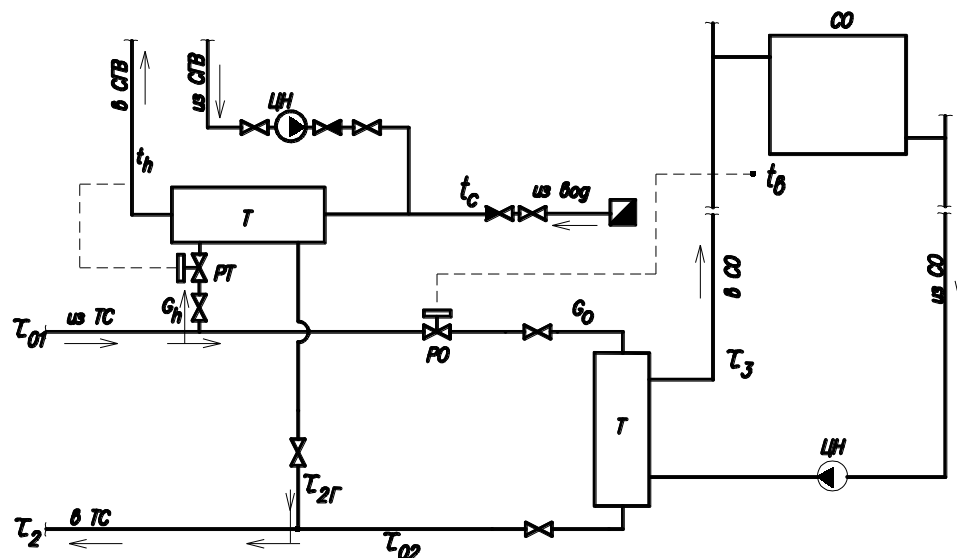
Параллельная схема присоединения систем горячего водоснабжения и отопления к теплосети
